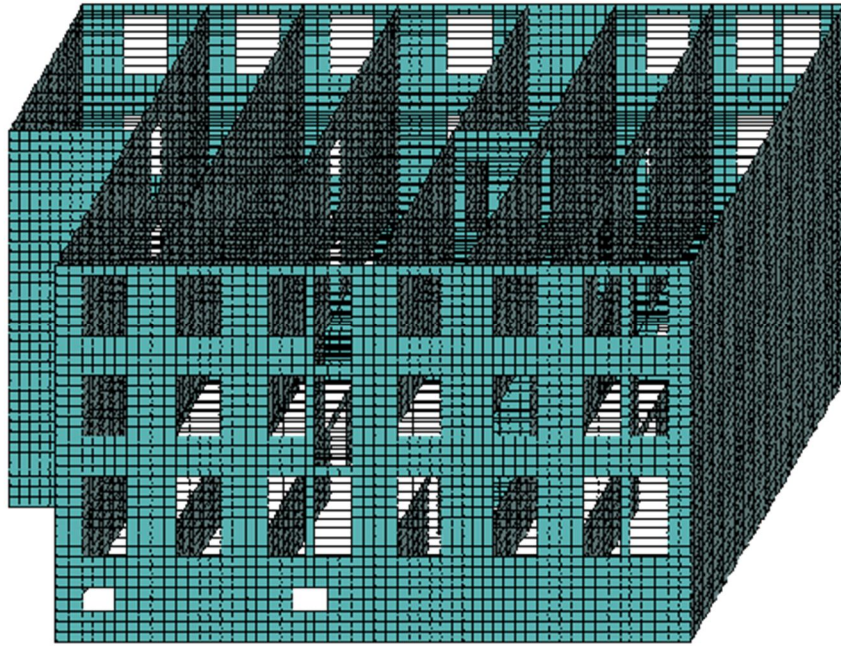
Розрахункова схема фрагмента будівлі.
